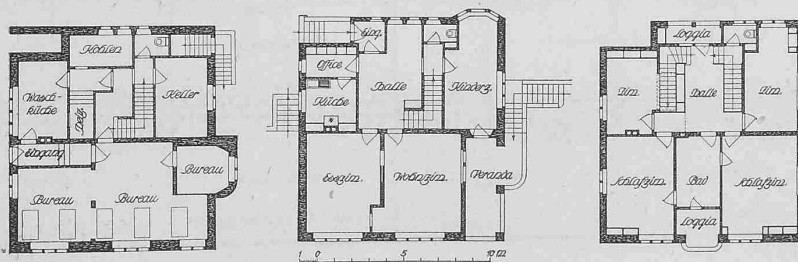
bis 6. Grundrisse des Hauses Keltenstrasse Nr. 30. — 1:400.
